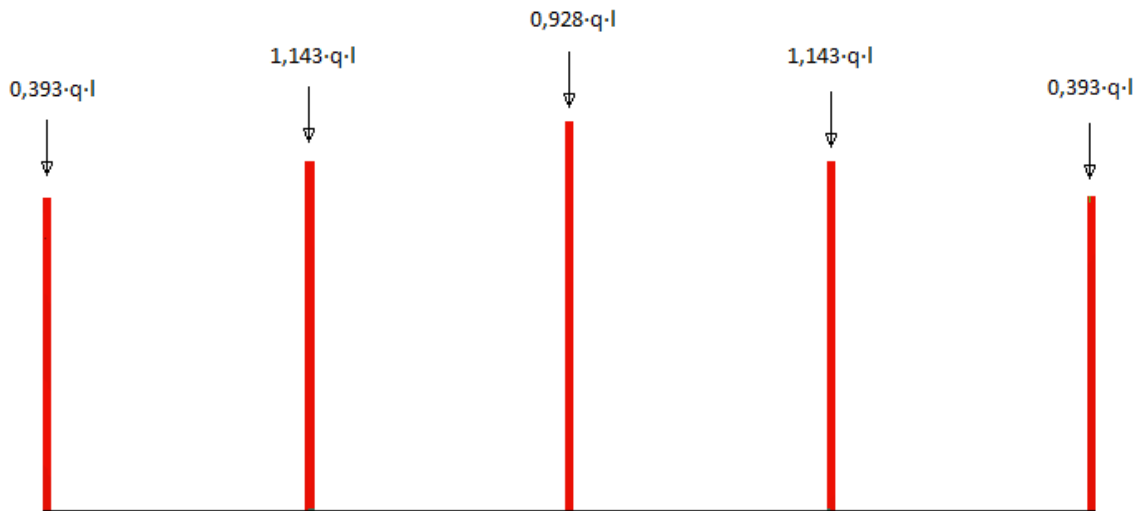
Axiles sobre los pilares del pórtico de fachada.
